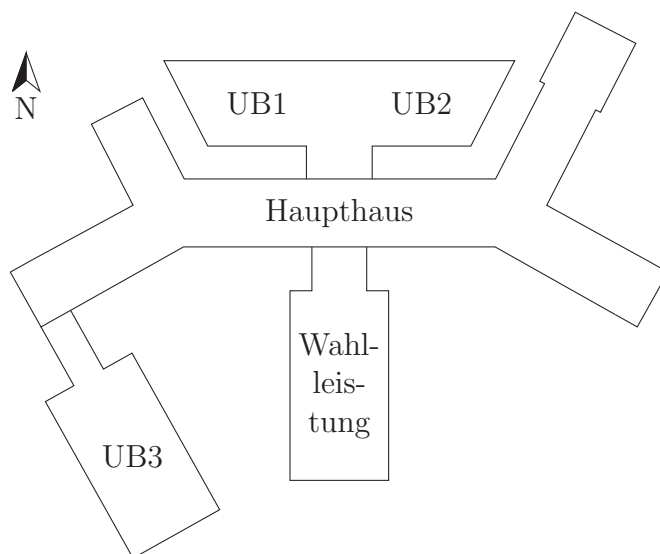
Grundriss des Krankenhauses
